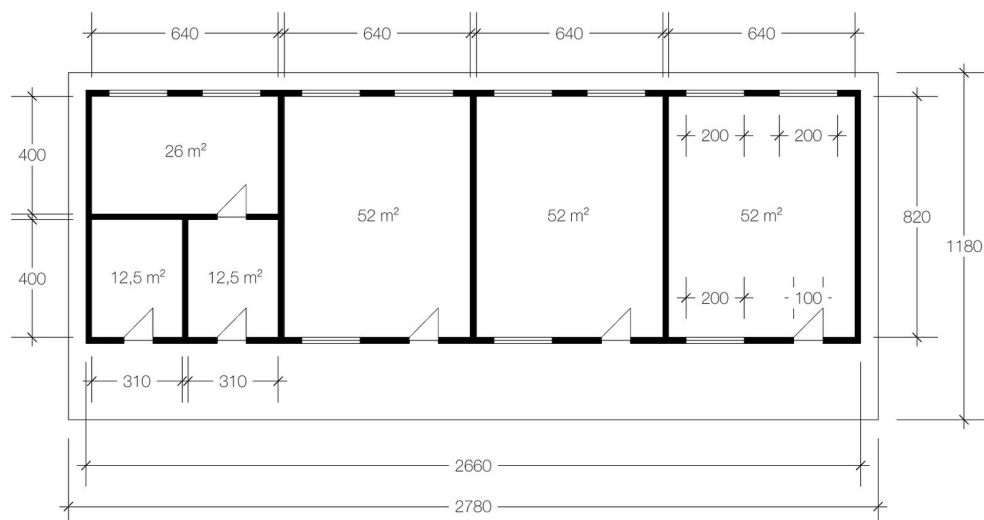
Grundriss des Erweiterungsbaus (April 2017)
